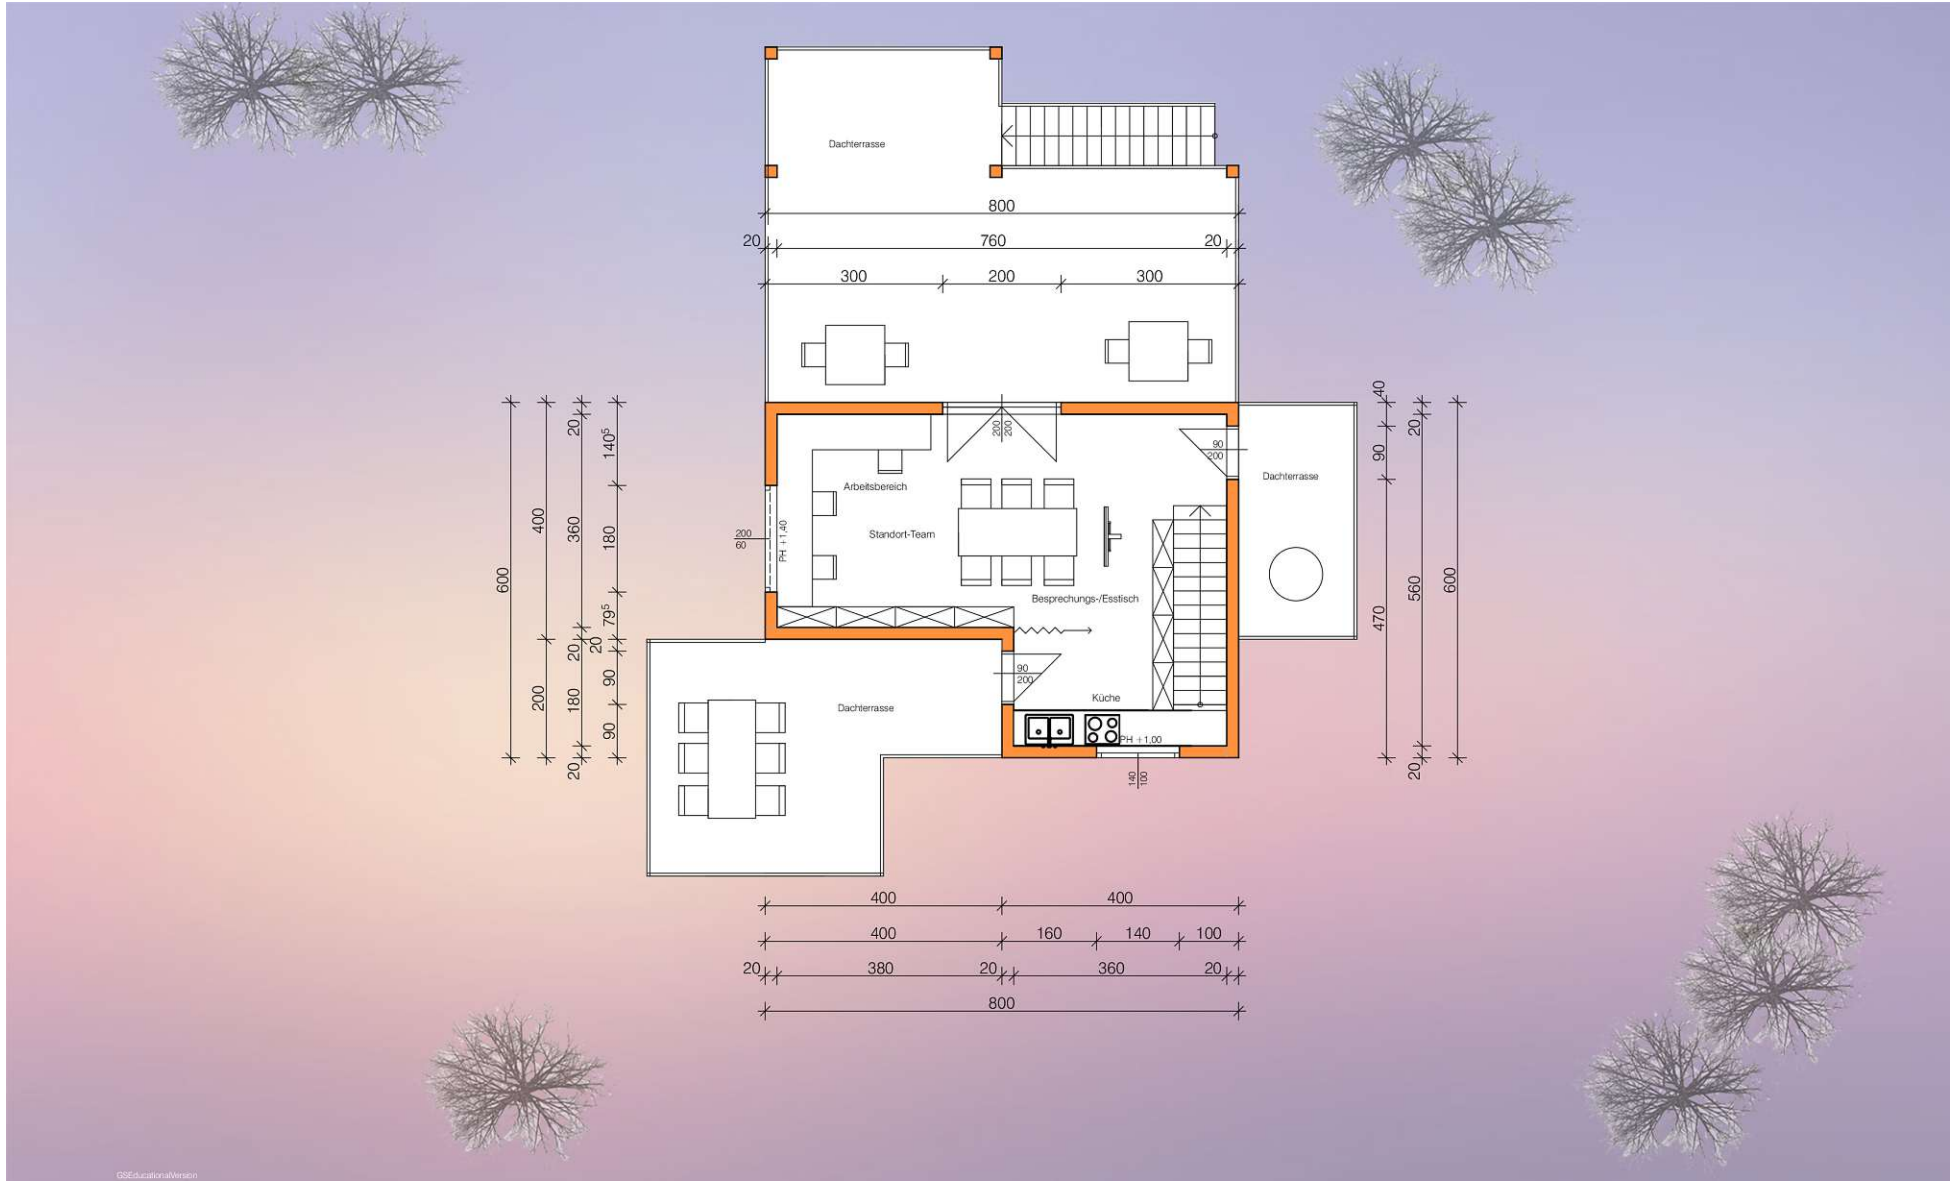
GRUNDRISS HAUS A - OBERGESCHOSS 1:100
